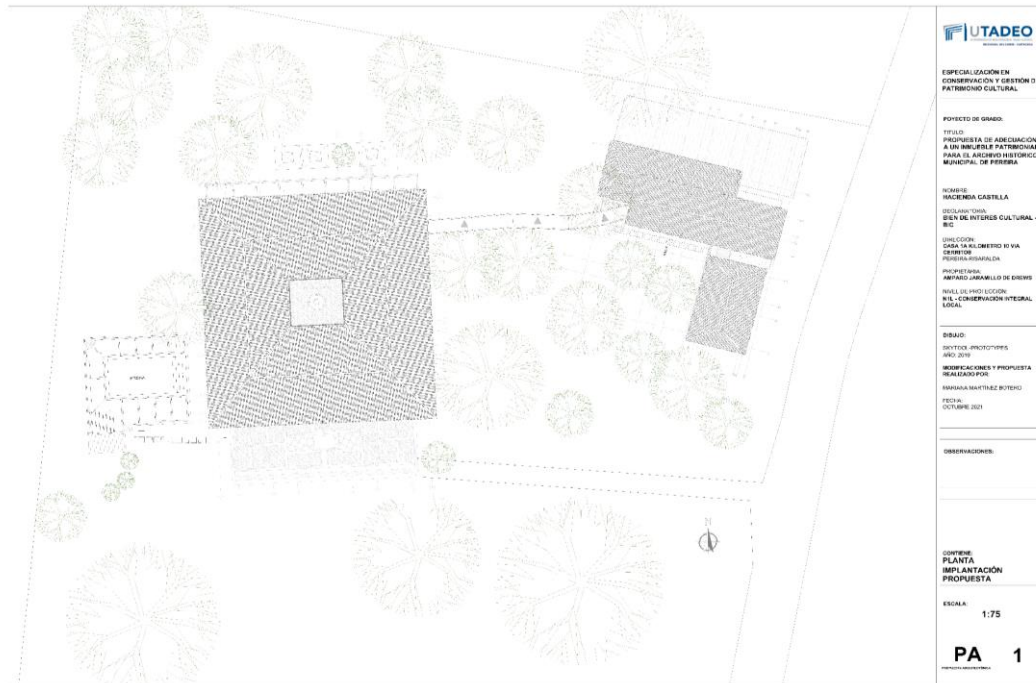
Propuesta Arquitectónica- Implantación. Fuente: Propia
